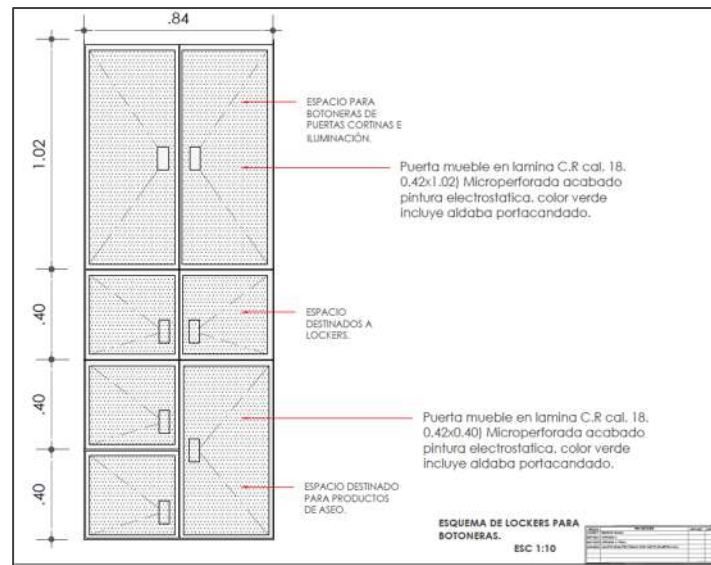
Esquema de locker para el módulo de abordaje. Plano 6. A-101 PLANTA 1ER PISO-A-101_2 ESQUEMA LOCKERS PARA BOTONERA .dwg.
